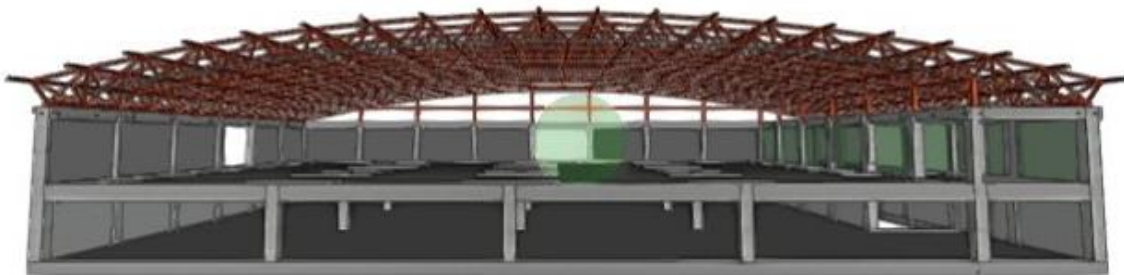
Sección por eje de simetría X viendo la estructura completa.
